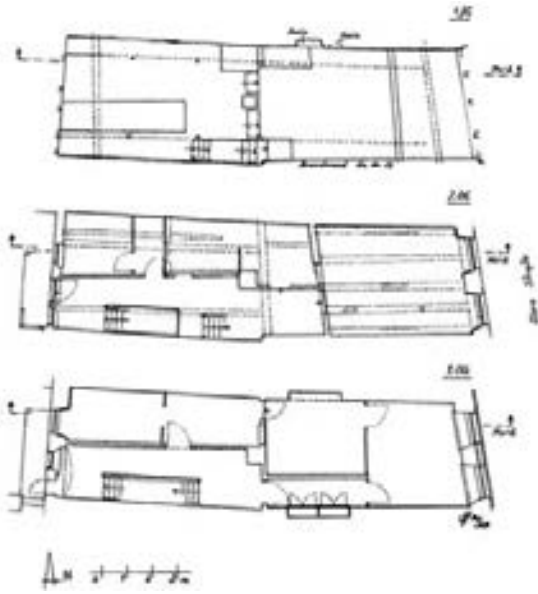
Villingen, Obere Straße 25. Grundrisse 1. DG, 2. OG und 1. OG, von oben.
